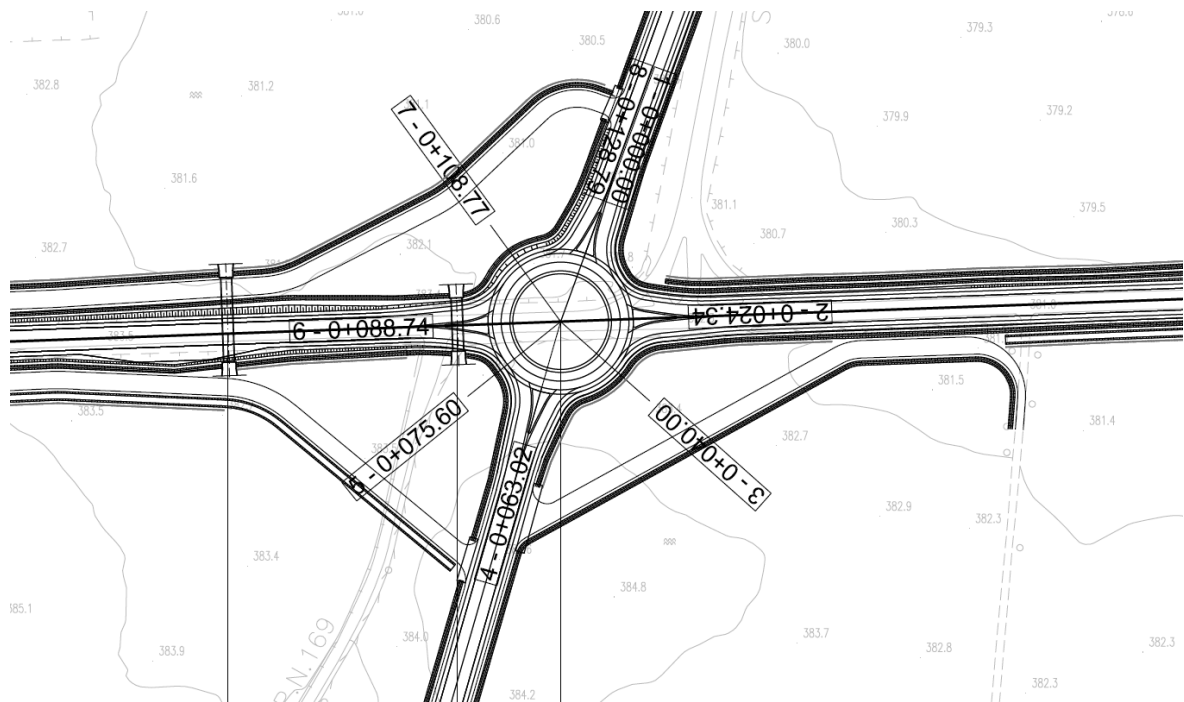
Planimetria di progetto Rotatoria 4- Km 5+386,68
